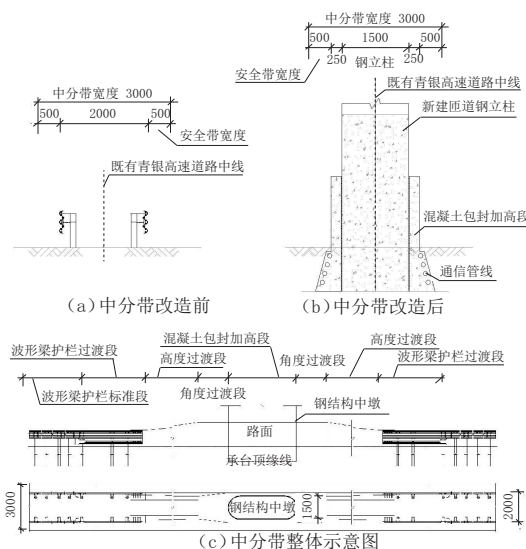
高速中分带内桥墩混凝土包封及护栏过渡示意图(单位:mm)
